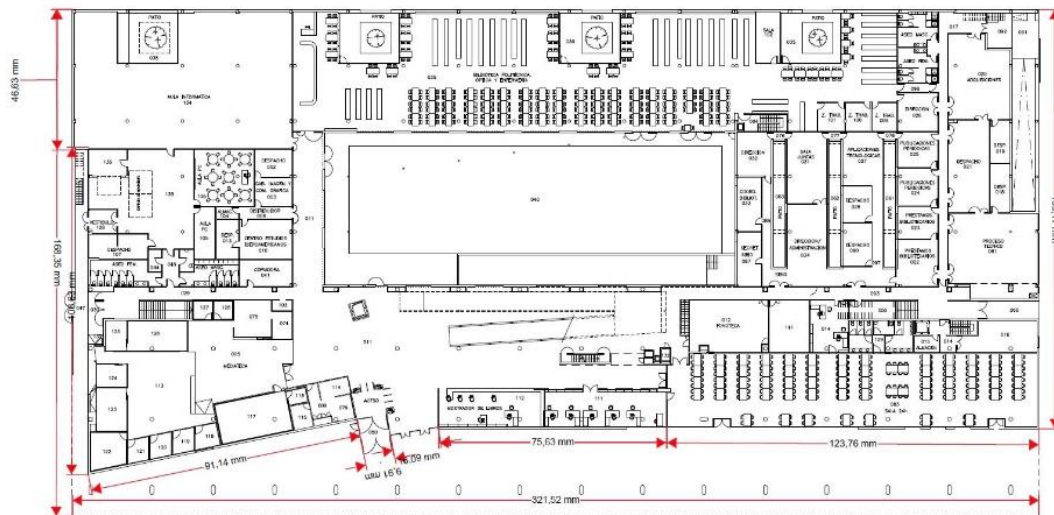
Medidas de las paredes exteriores de la planta baja de la Biblioteca
